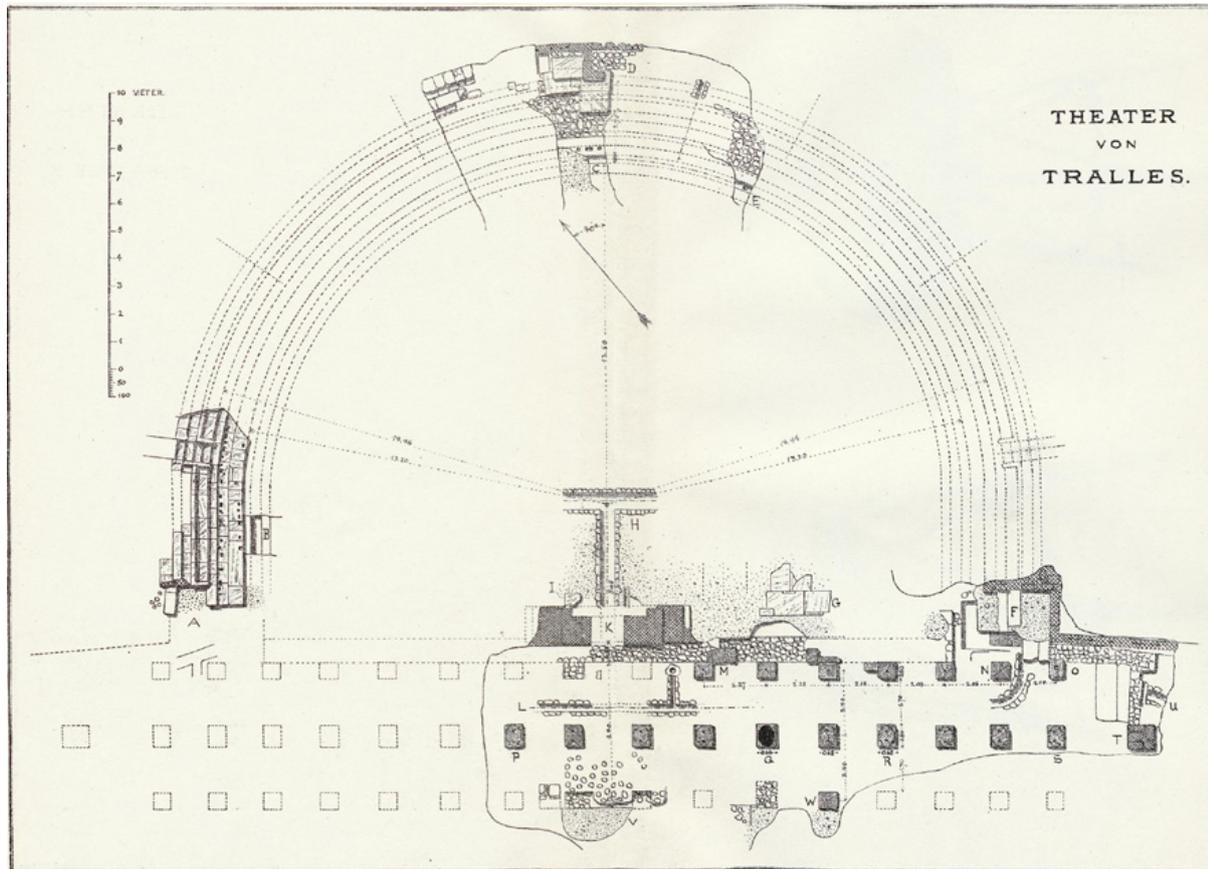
Tralleis, Grundriss des Theaters.
